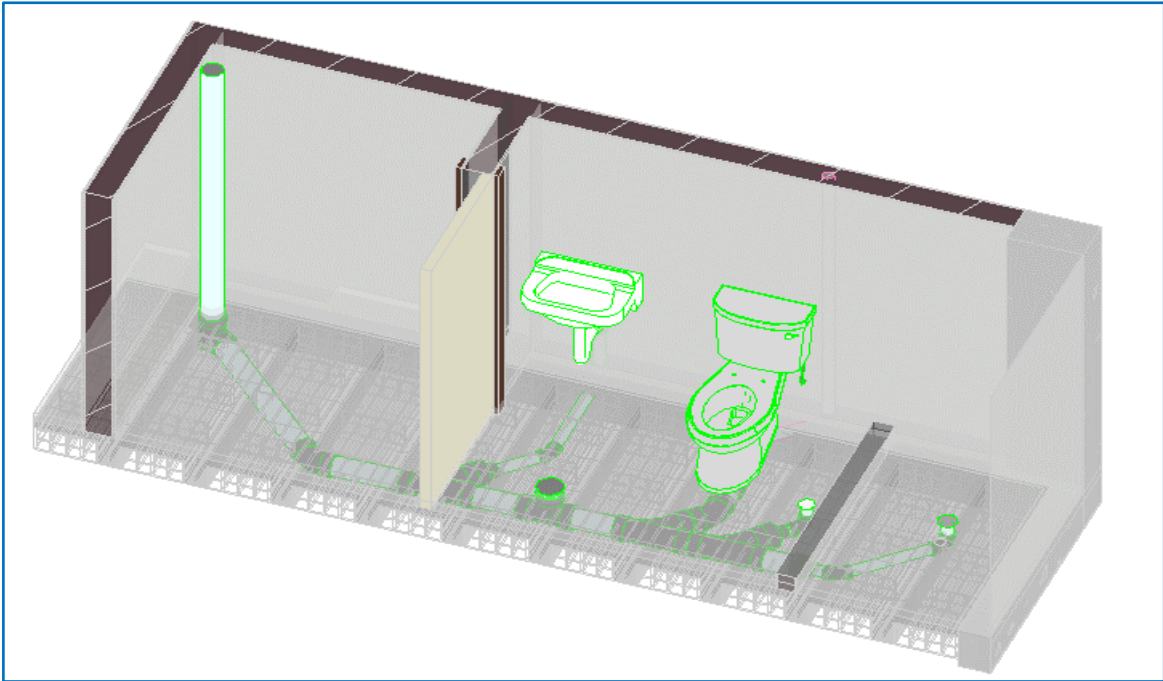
Vista 3D de estructuras de la edificación en Revit
